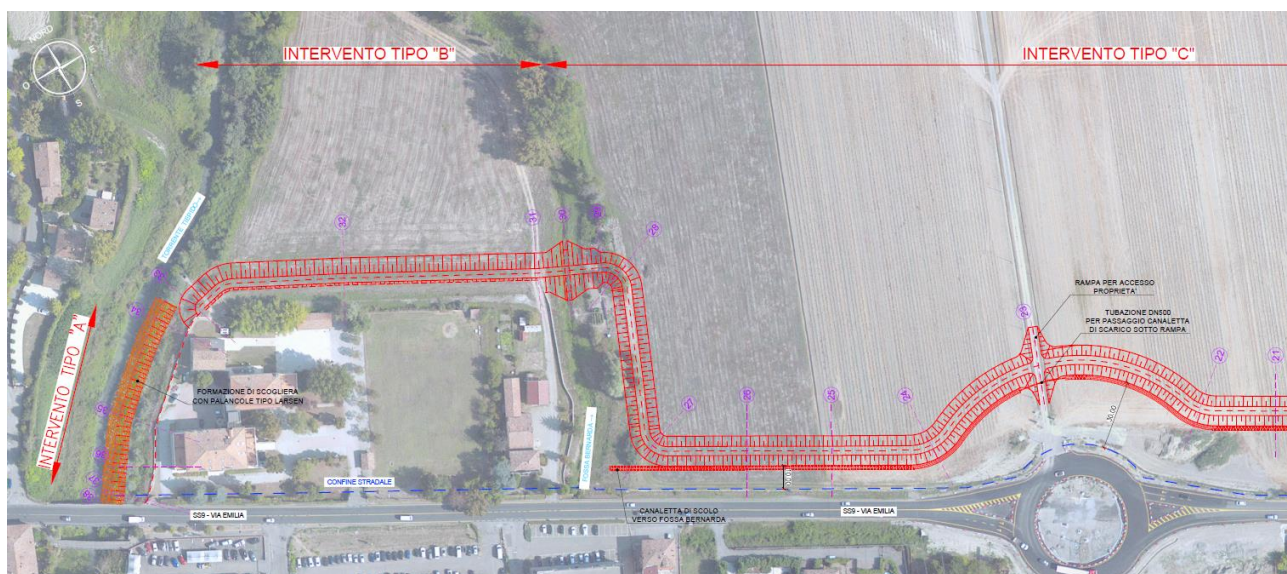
Stralcio planimetria di progetto (2 di 4).
